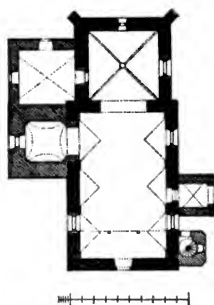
Bukovsko Ober-. Grundriss der Kirche.
